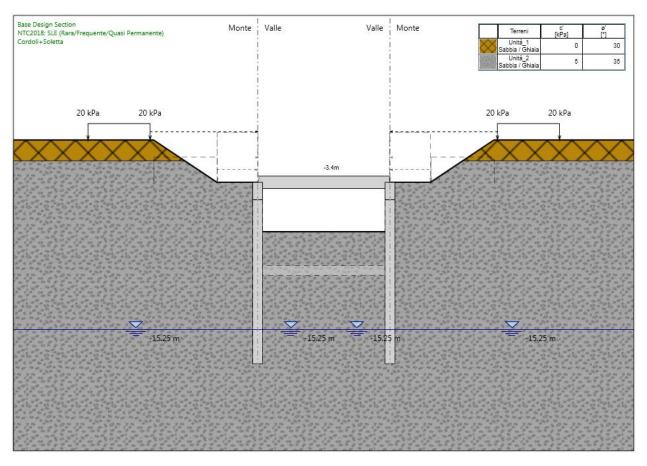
Fase 7: realizzazione piedritti di sopraelevazione e soletta di copertura
